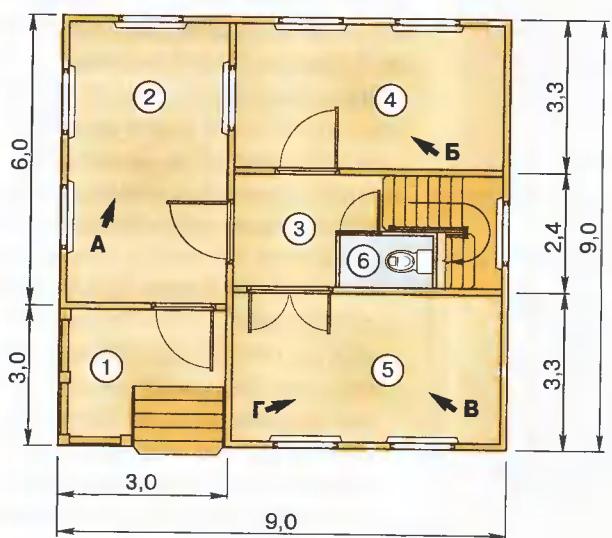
План первого этажа: 1 — крыльцо; 2 — веранда; 3 — холл; 4 — кухня-столовая; 5 — гостиная; 6 — санузел
